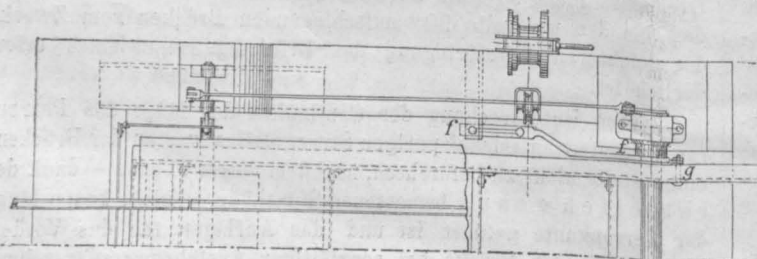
Grundriss bei geöffneter Brücke.
